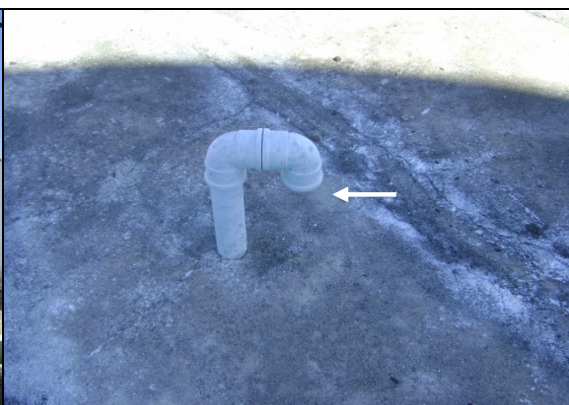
RAP-02: Tubulação de ventilação sem tela de proteção.
